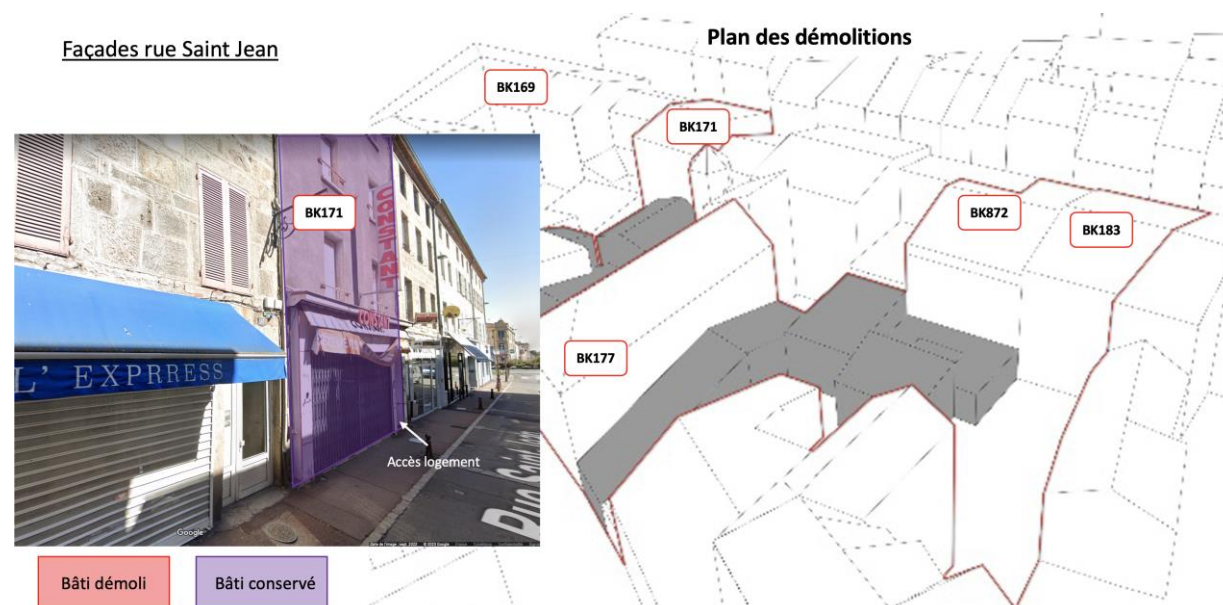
Repérage des façades conservées sur la rue Saint-Jean - 2/2
